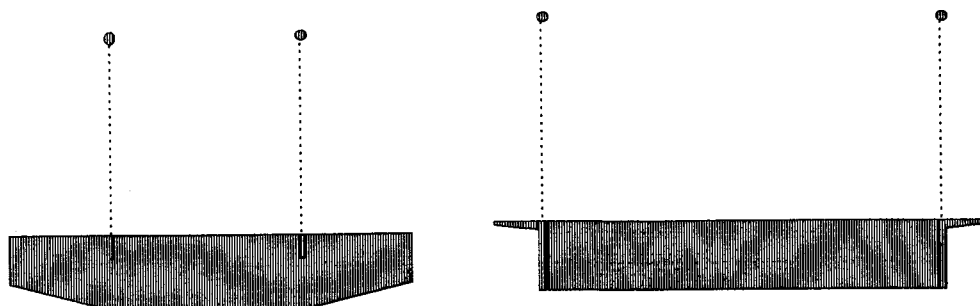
Sistemas de dois cabos planos: (a) posicionados entre vias de tráfego; (b) posicionados externamente às vigas.
